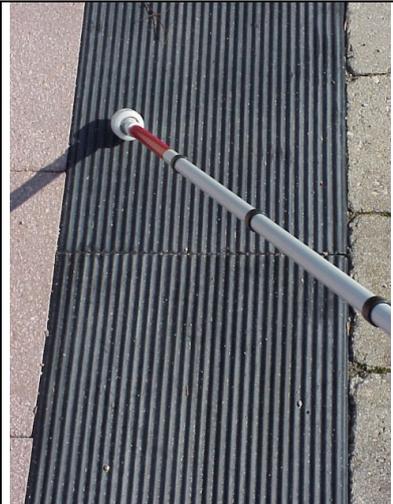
f: Hartgummi-Rillenplatte (Hamburg)
